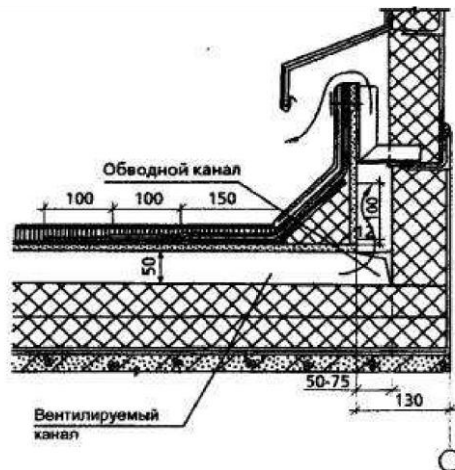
Примыкание конструкции фонаря к утепленному покрытию
